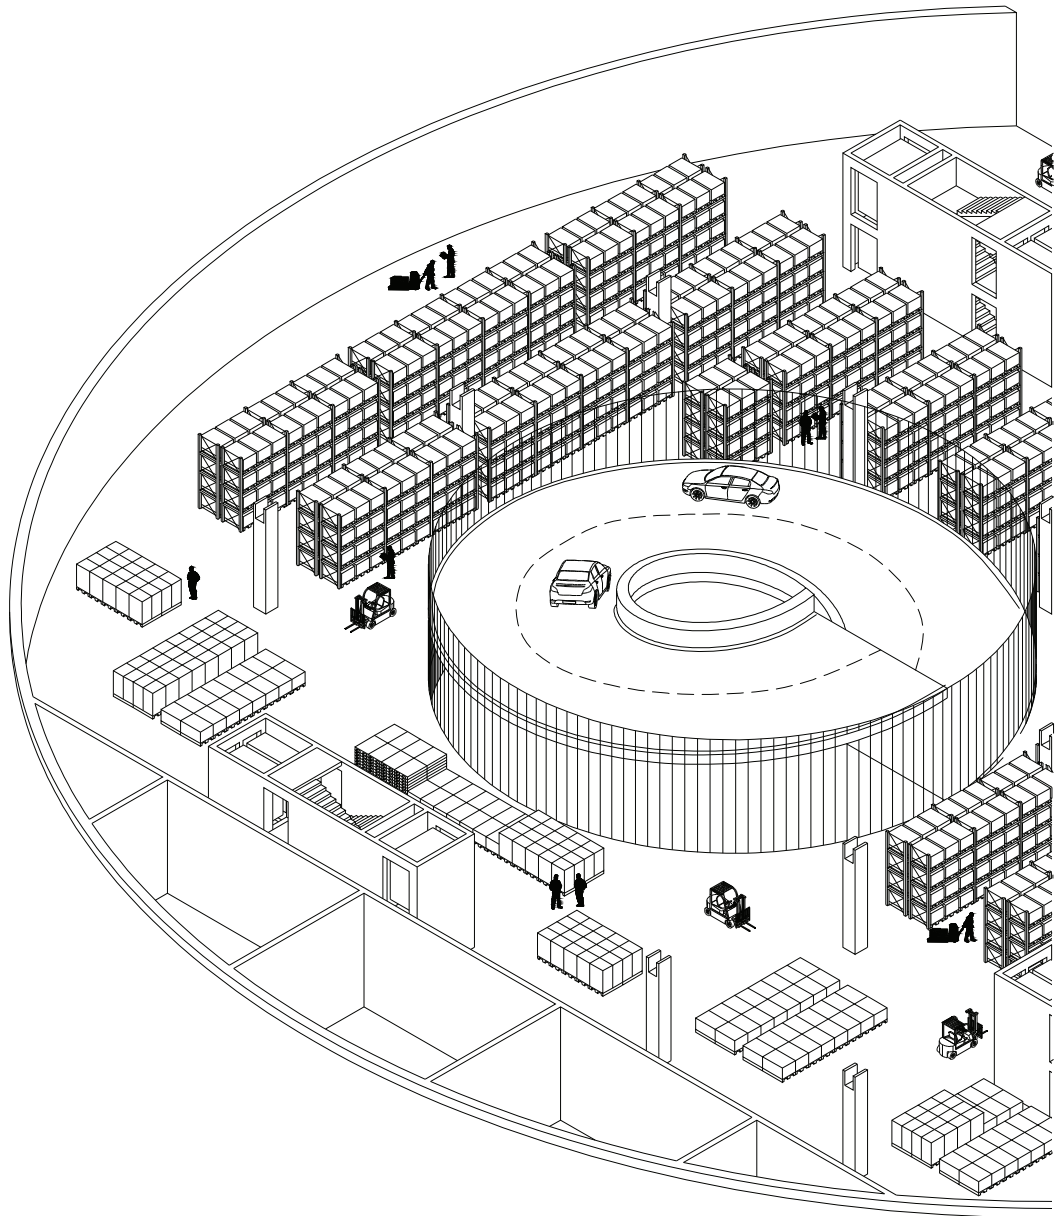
Grundriss . Obergeschoss (+78) . 1:750
